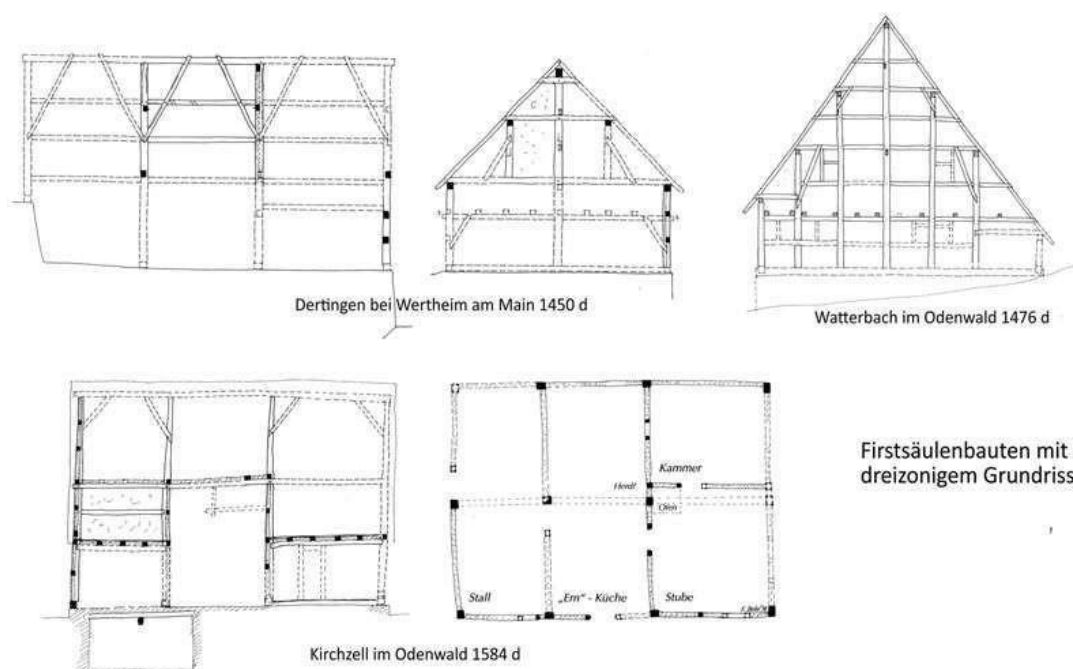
Конькові колонні будівлі з тризонним планом поверху (креслення реконструкції Конрада Бедала) [45].
